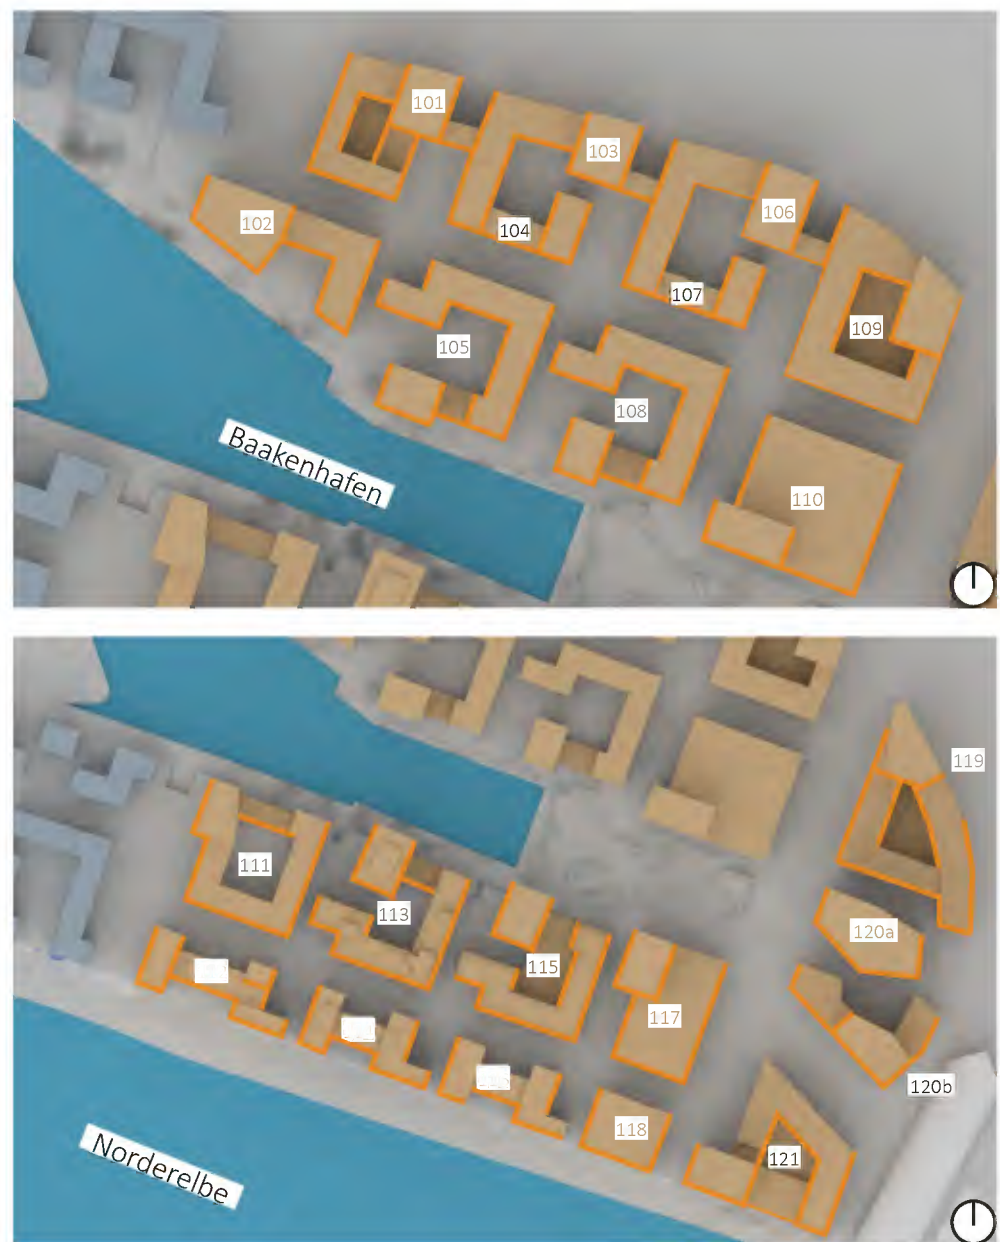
Lageplan mit Baufeldern und untersuchten Fassaden (Entwurf), ohne Maßstab.
